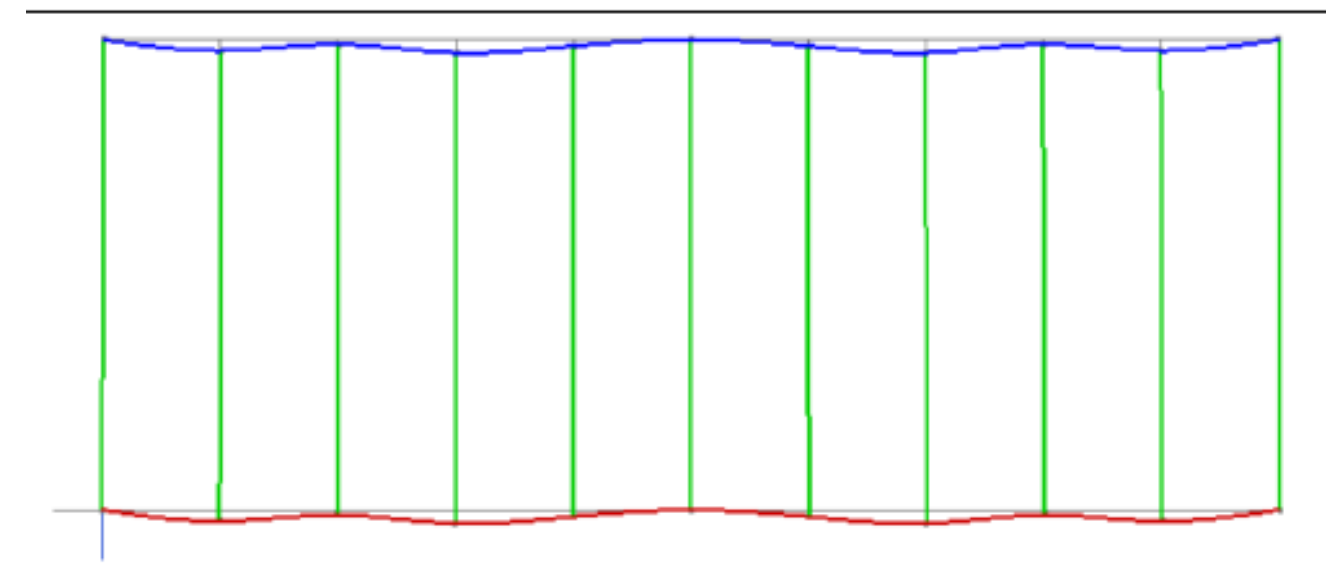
Façade Filante posée avec appuis multiples en bandes horizontales
